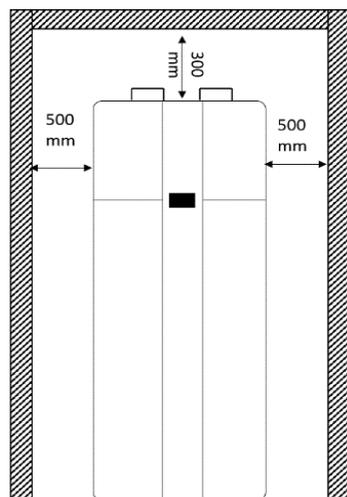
Distanza minima dalle pareti di un'unità sprovvista di condotto aeraulico
